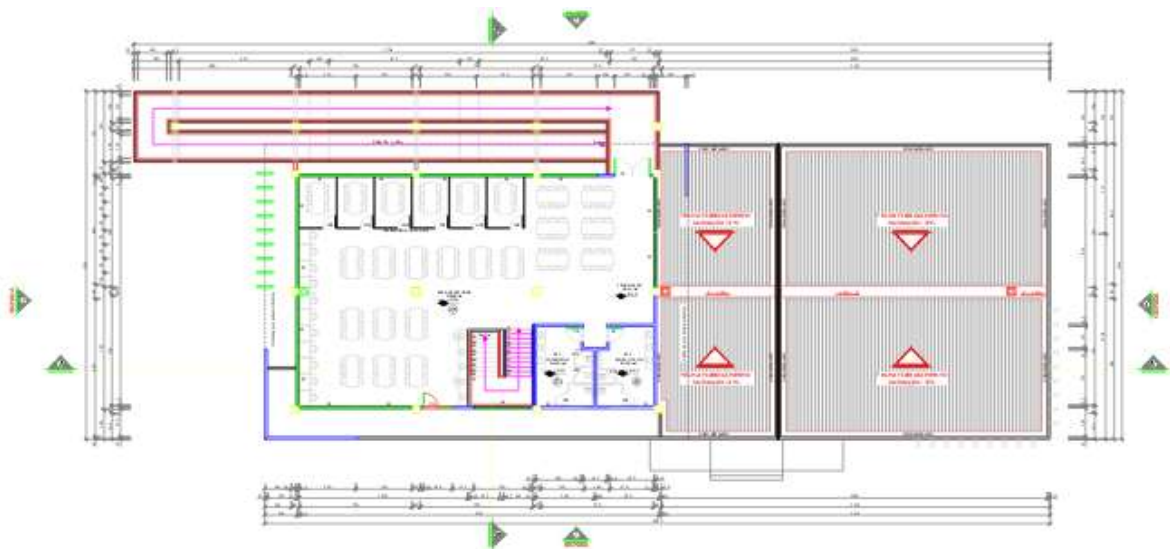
Planta física do pavimento térreo<sup>1</sup>
